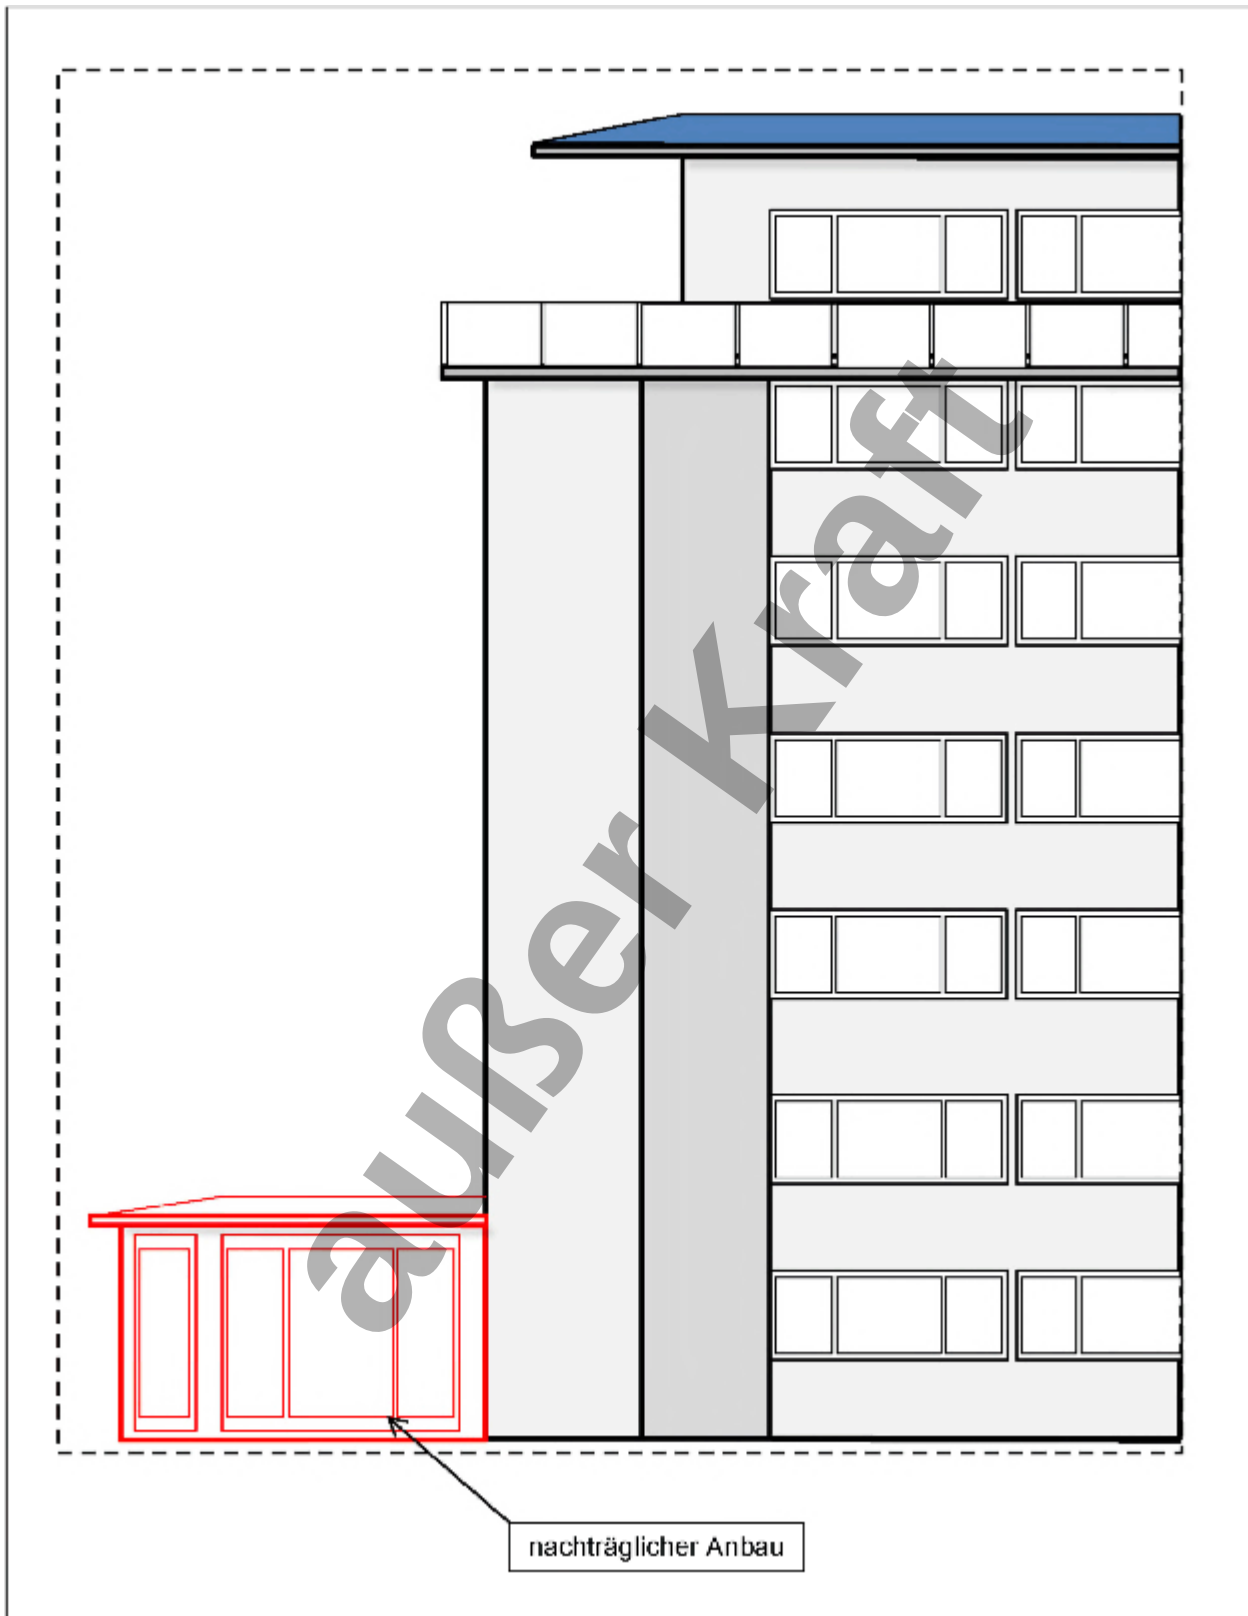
Anbau bei prüfpflichtigen Gebäuden
